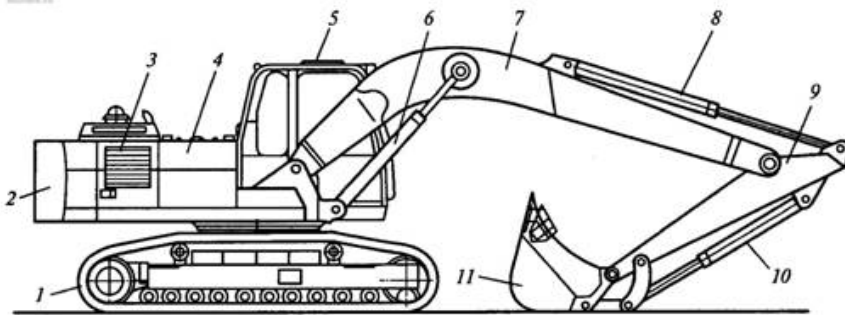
Одноковшевий повноповоротний гусеничний екскаватор:
